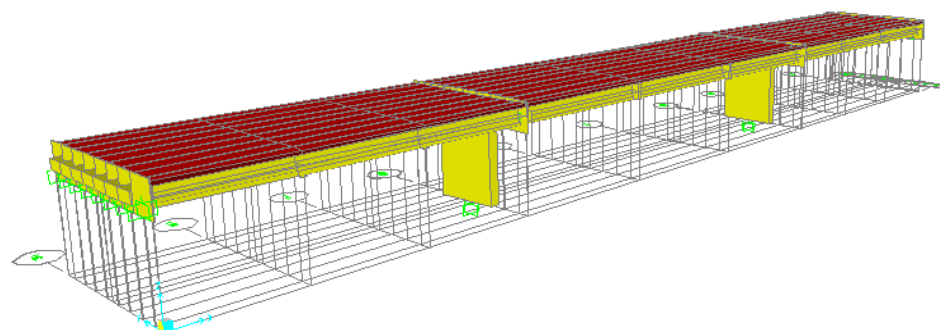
Modelo analítico del Puente Copándaro II con pilas tipo muro (elementos tipo “FRAME”), “Extrude View” (SAP2000).
